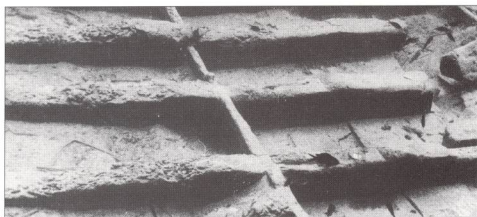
Vista general de las zonas elegidas para las pruebas.
